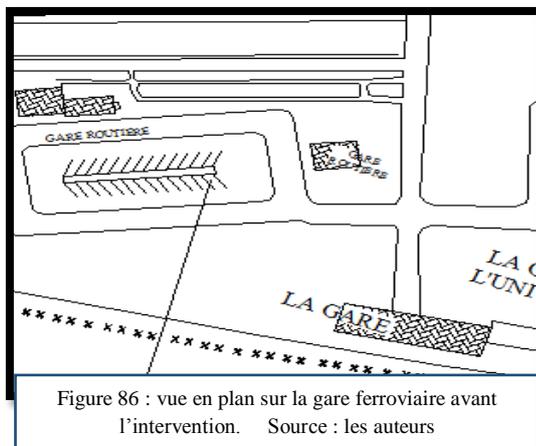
vue en plan sur la gare ferroviaire avant l'intervention. Source : les auteurs
